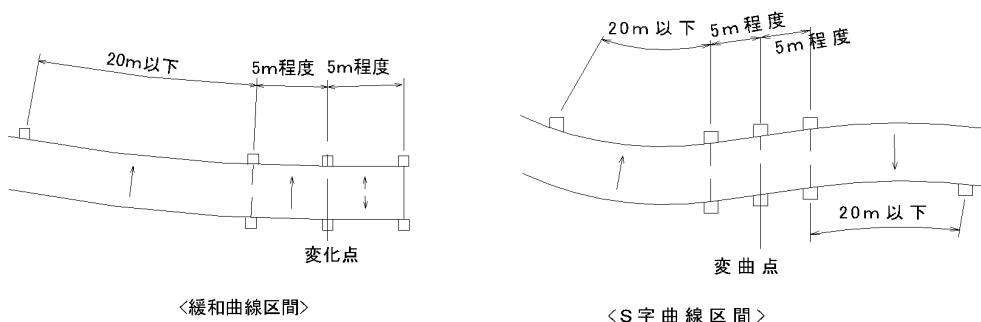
変曲点付近の排水樹の設置方法（平面図）
